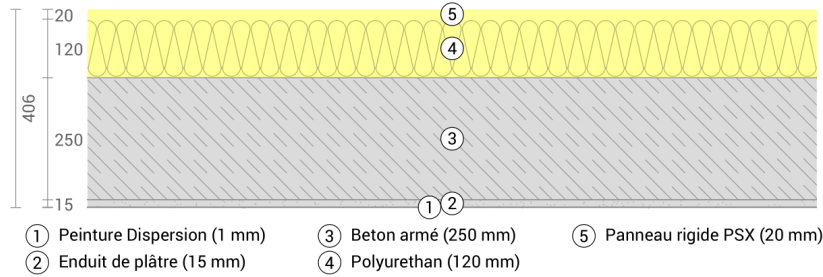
Composition de la dalle entre le rez-de-chaussée et l'étage supérieur
